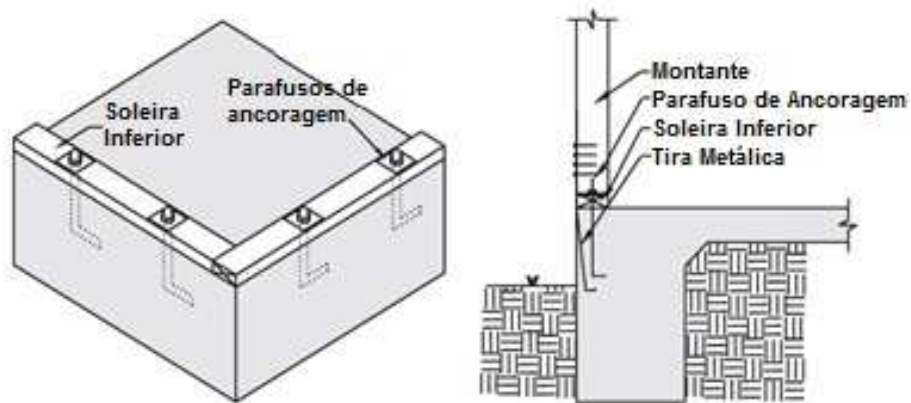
Conexão entre paredes e laje de fundação. [adaptado de WFCM for One- and Two-Family Dwellings (2015)]
